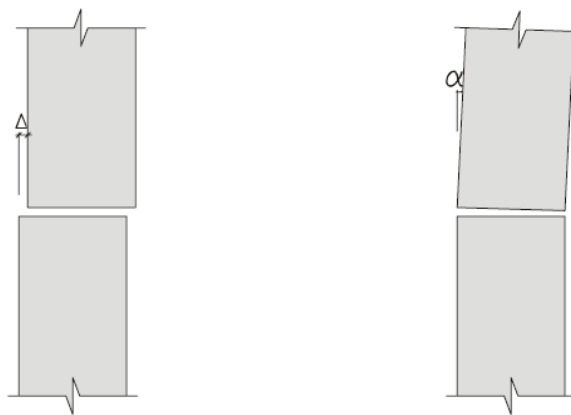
desvios de posicionamento na secção transversal dos painéis no plano da fachada
